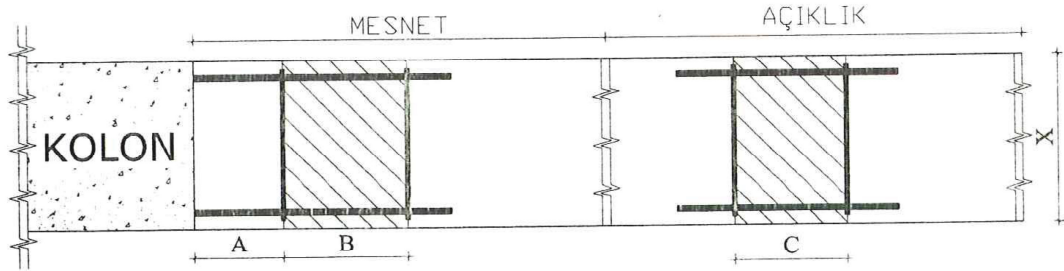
Paspayı sıyrılarak yapılan kolon donatı tespit tutanağı-yapı elemanı TT-Z-P1.
